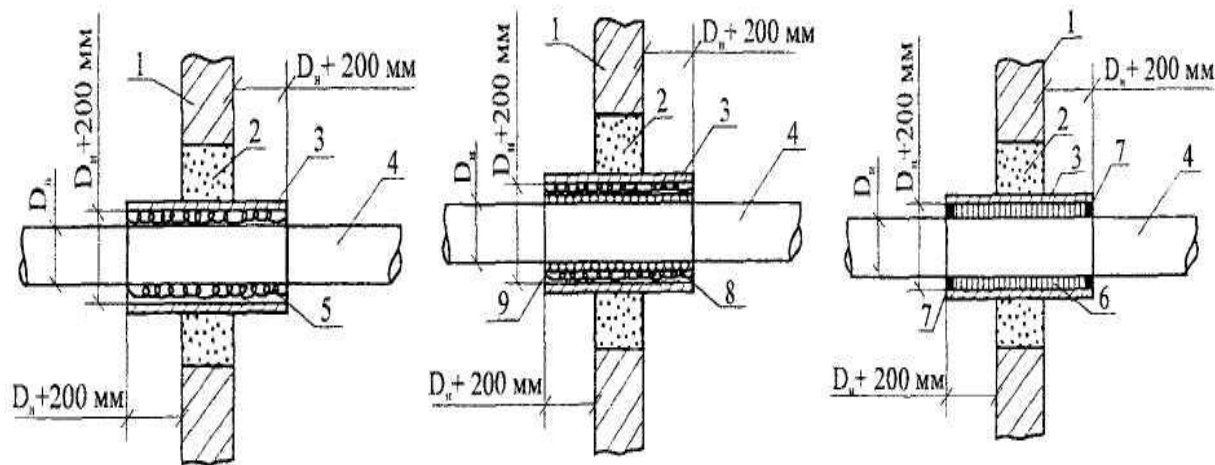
Схемы заделки ПВХ труб в стене здания (ЦТП, камеры)
